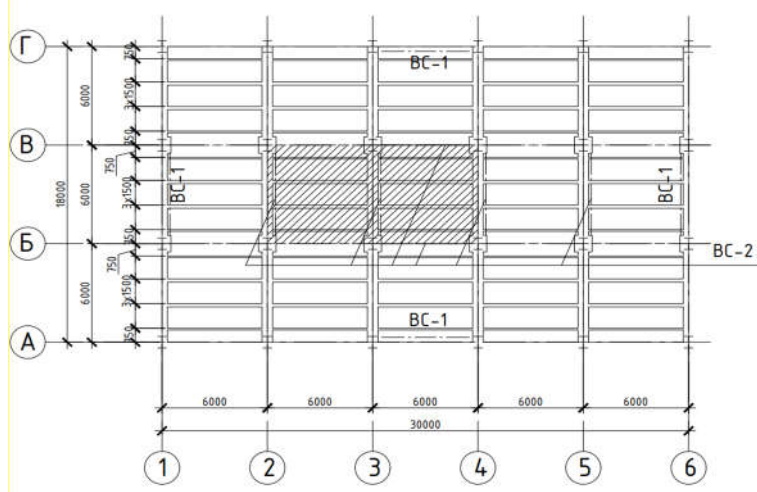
Схема розташування елементів перекриття. ВС-1, ВС-2 - вертикальні в'язі по колонах.
